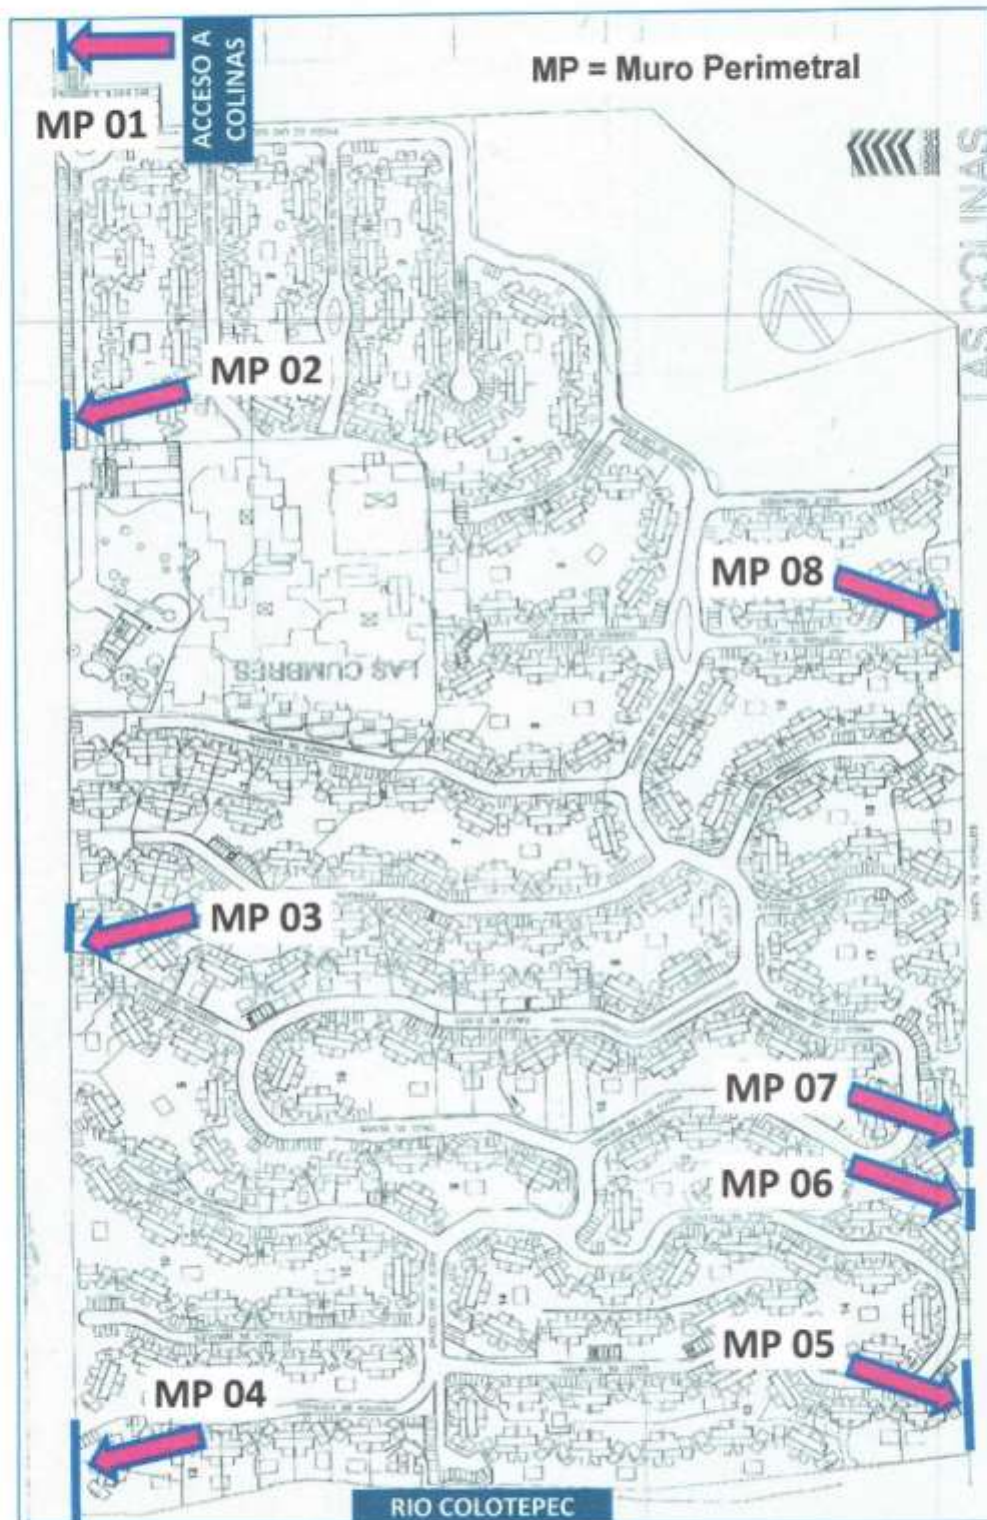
Ubicación de Muros Perimetrales dañados o colapsados.
